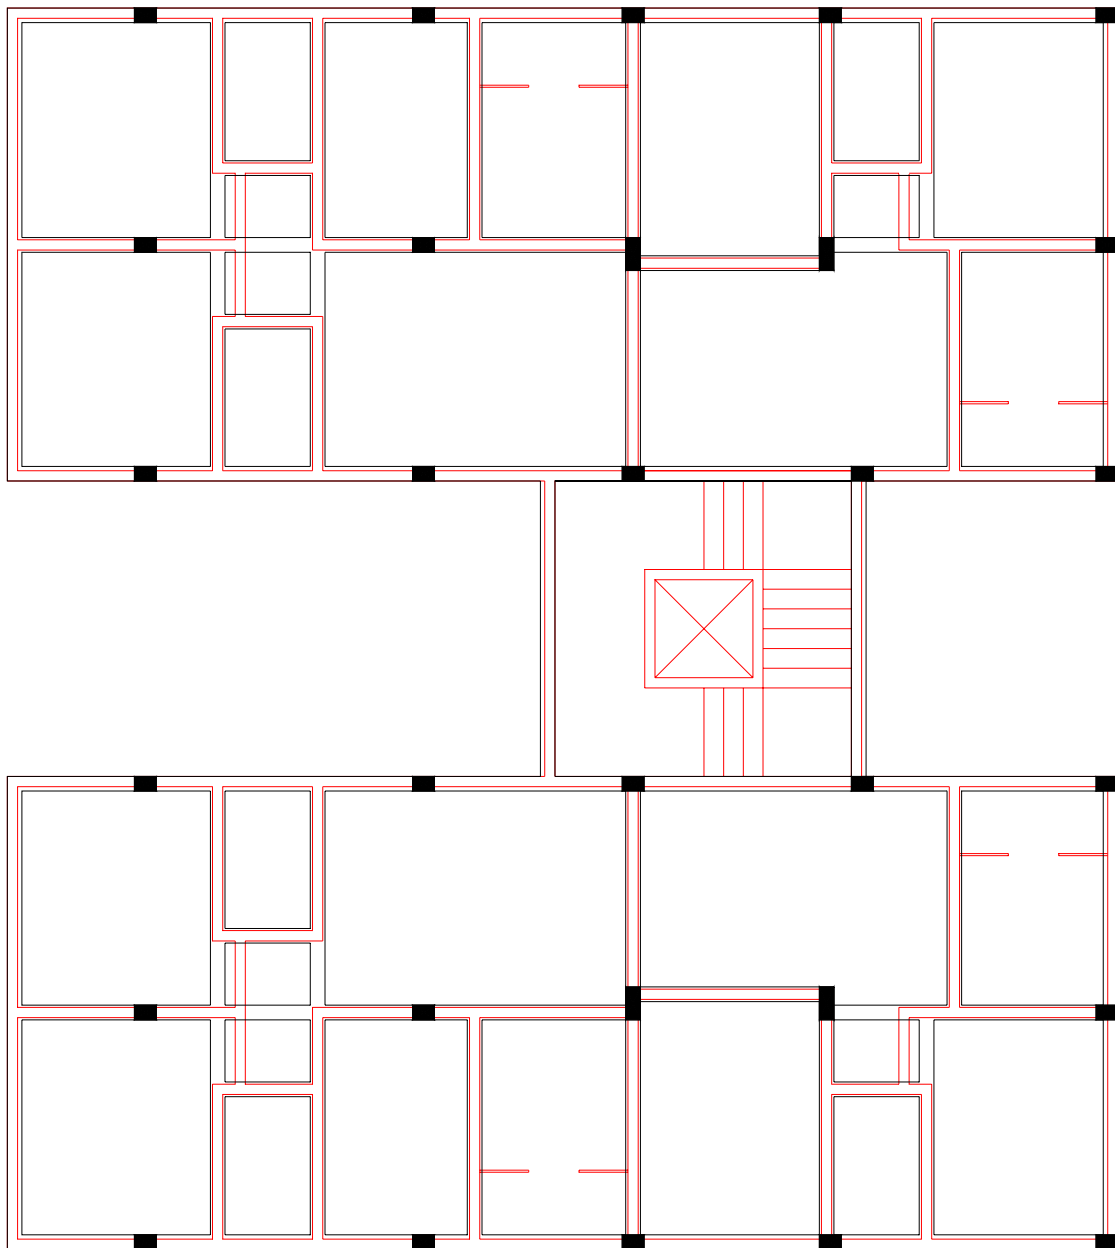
Prédio “A” – Opção 2 – Superposição das alvenarias do pavimento tipo sobre a estrutura
